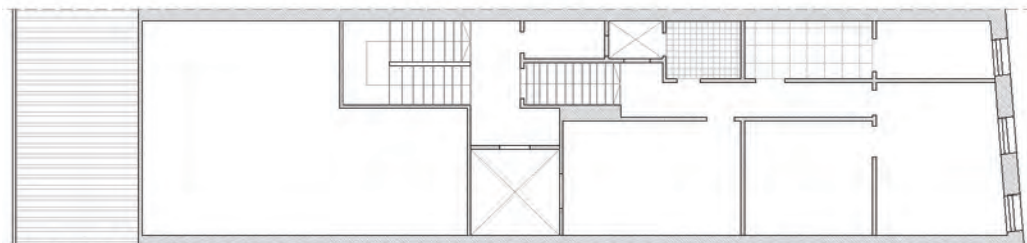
10. PLANTA BAJOCUBIERTA
